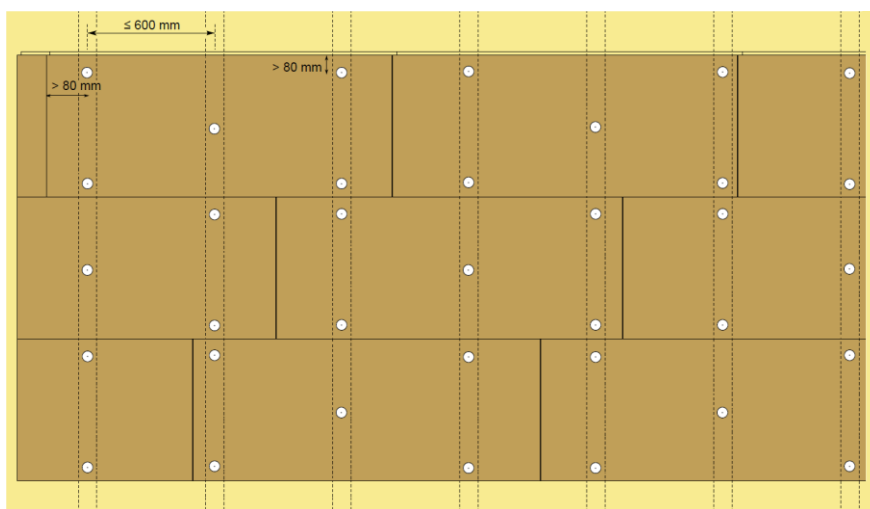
Fixation des panneaux isolants de dimensions 1430x560 mm par vis avec rosace – plans de fixation en partie courante
